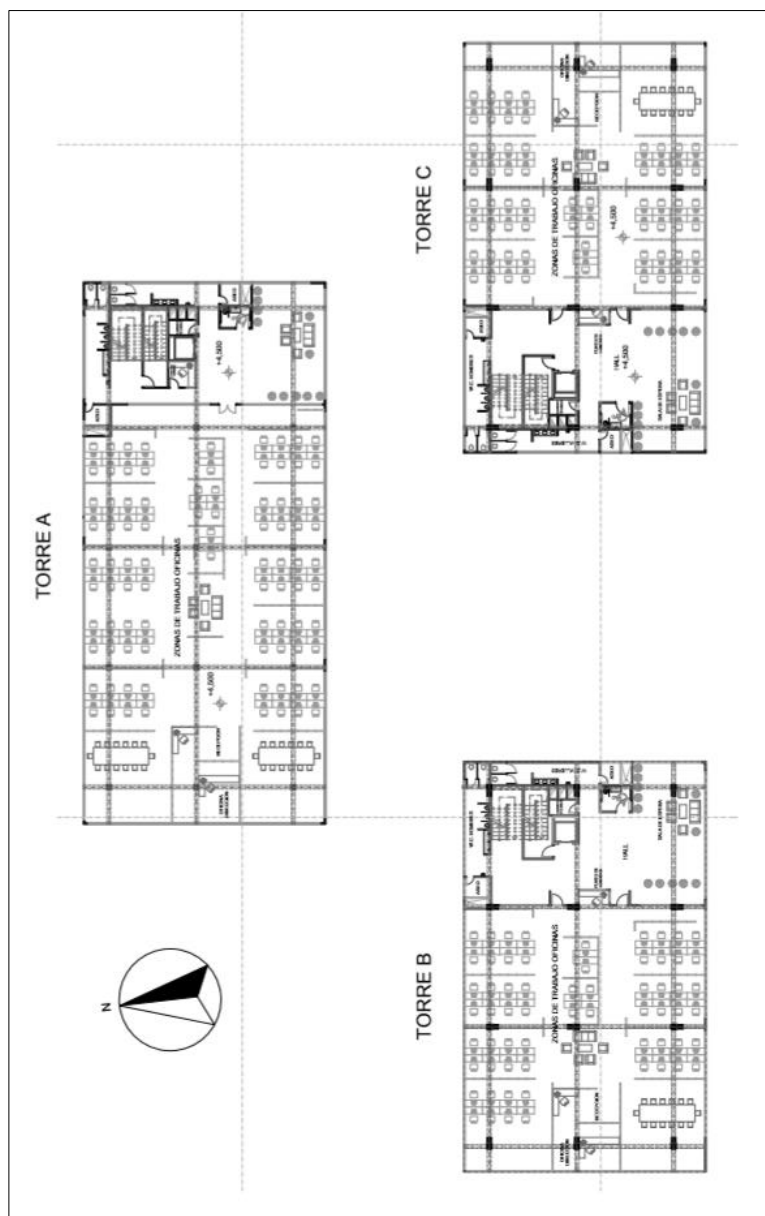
Planta arquitectónica tipo-niveles oficinas
